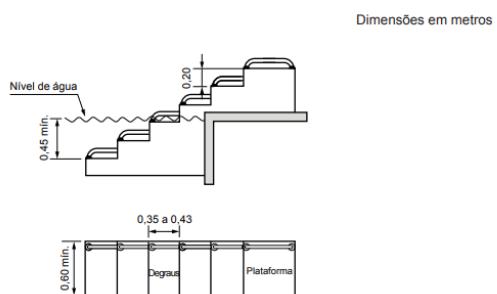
Escada submersa – Exemplo – Vistas lateral e superior
